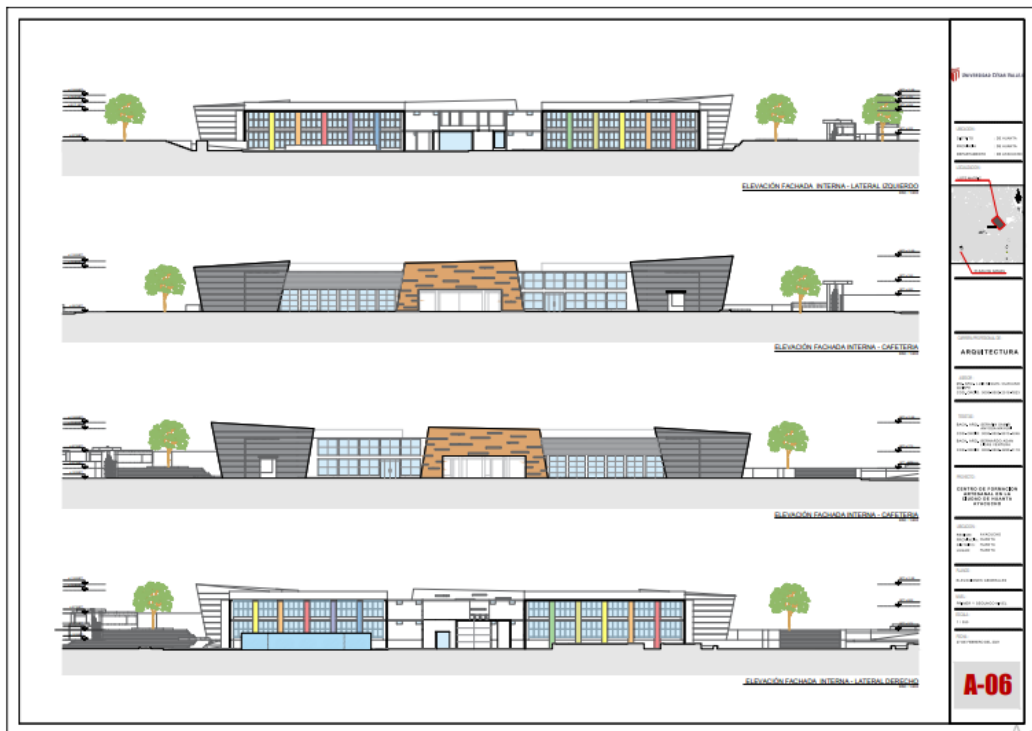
Elevaciones generales del proyecto escala 1/400.
